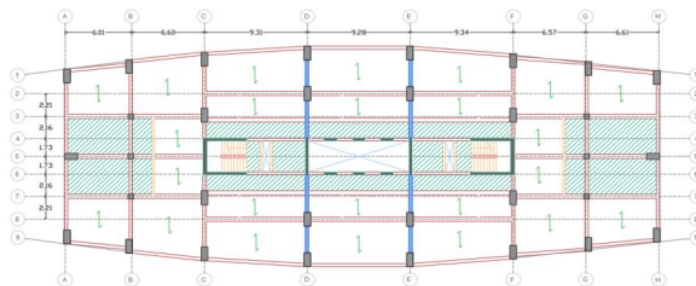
Encofrado para los niveles con outriggers, los cuales se muestran en color azul.
